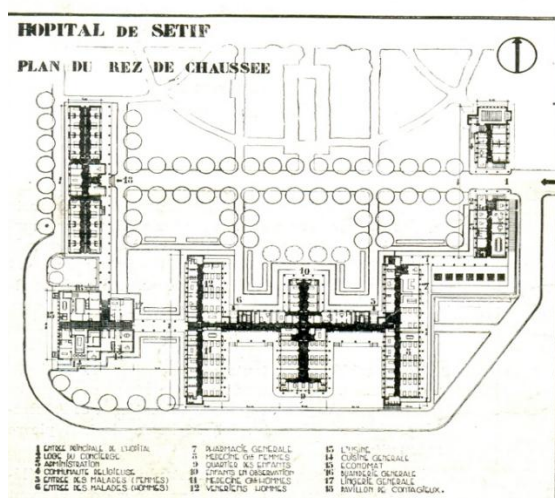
Vue en plan du rez-de-chaussée Figure 5.31 : Vue en plan du premier étage
